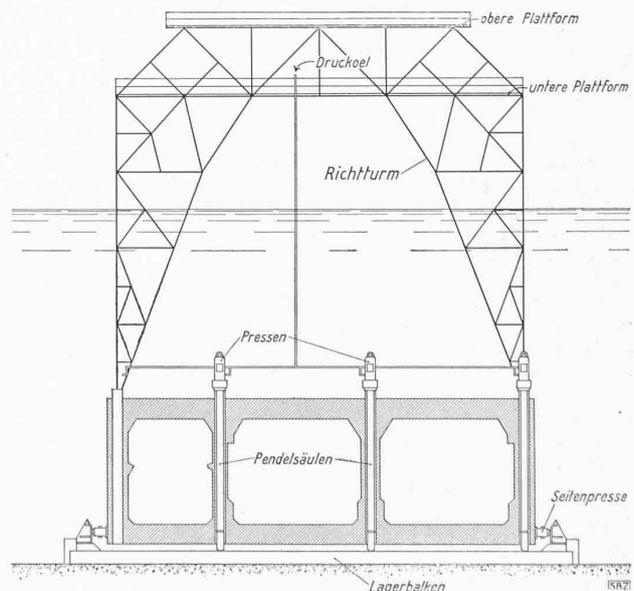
Schema der Auflagerung und Ausrichtung eines Tunnelstückes (äusserste Pendelsäule links nicht gezeichnet)
